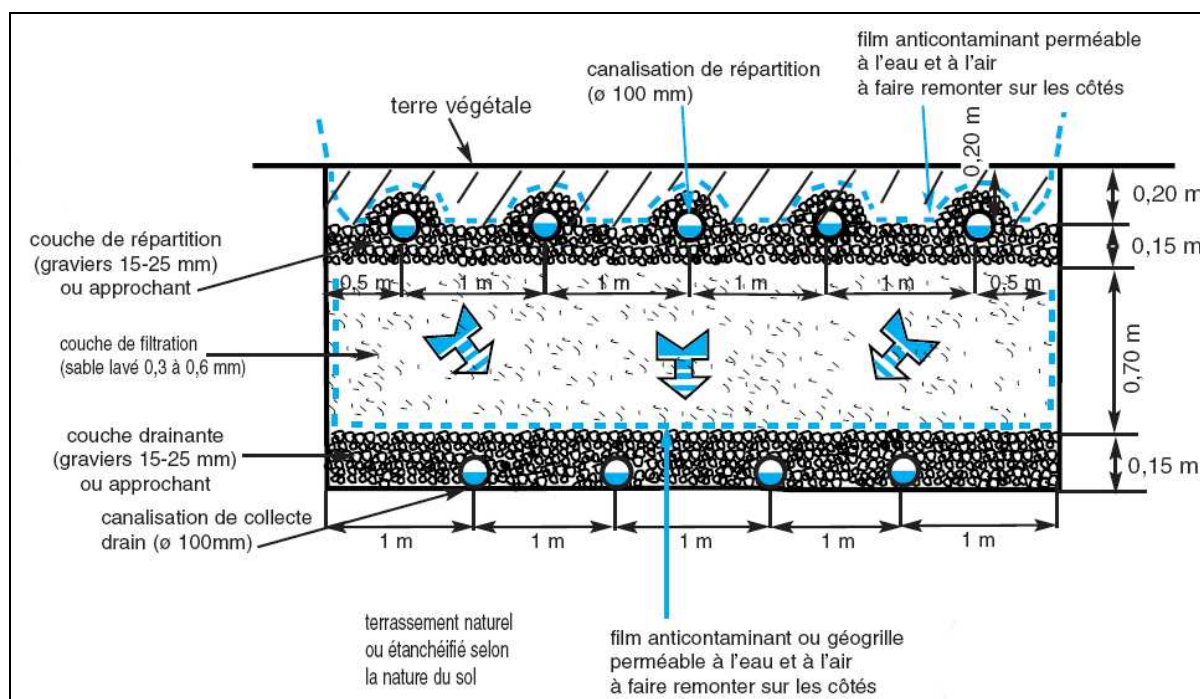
Coupe transversale d'un filtre à sable vertical drainé
